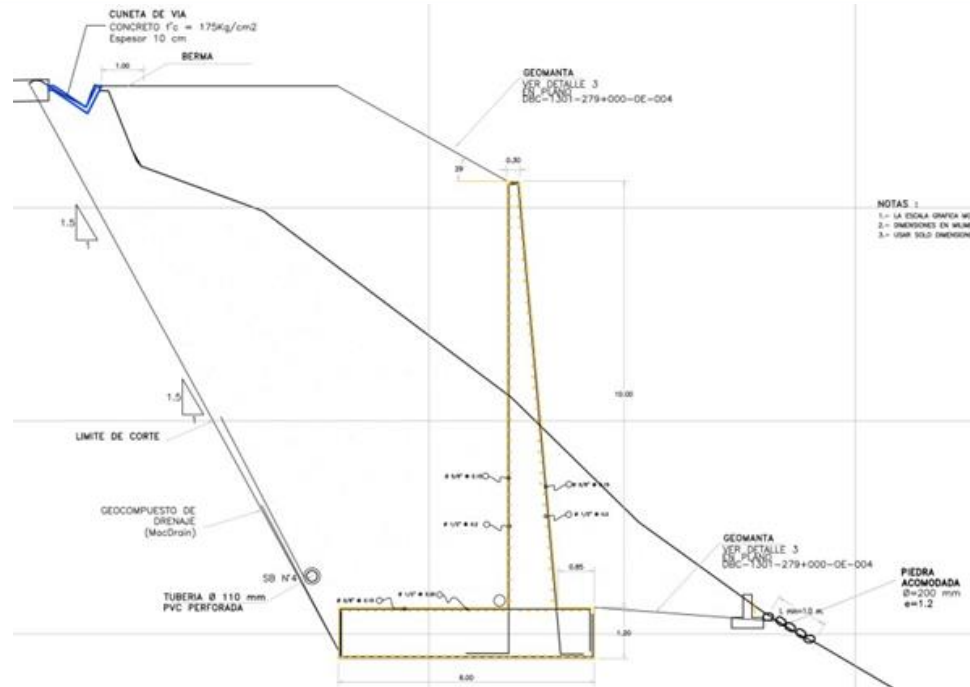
Esquema Muro de Concreto (Fuente: Odebrecht)
